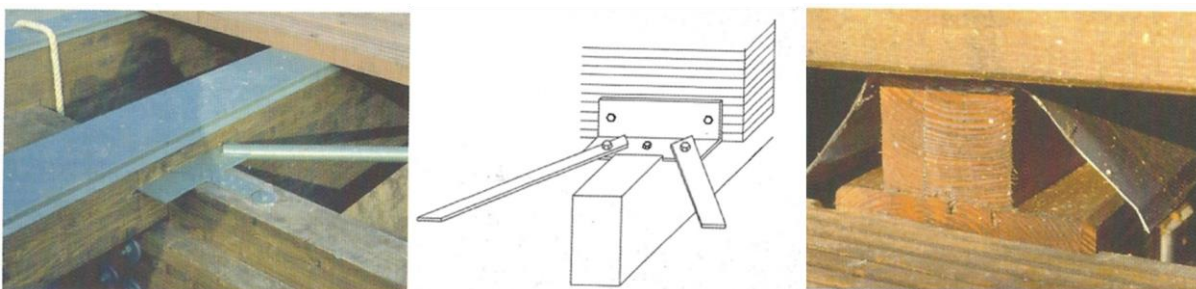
Utilización de chapas metálicas para proteger uniones o elementos principales
